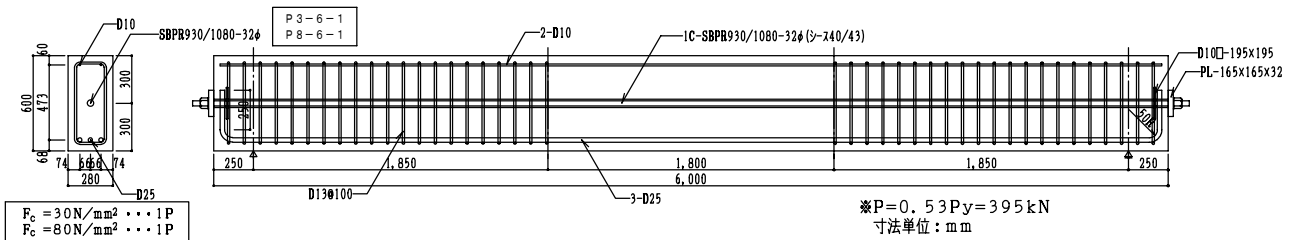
試験体配筋例 (P3-6-1, P8-6-1)
